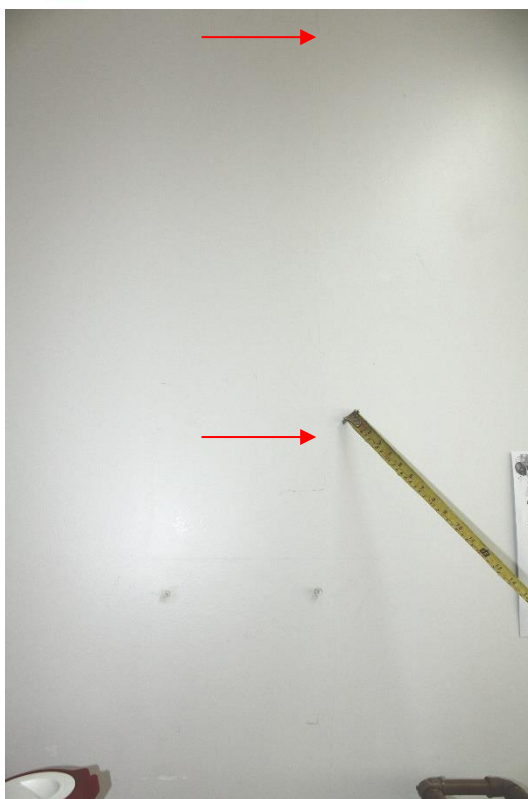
Em detalhe a Foto supra, destacando fissura vertical.
